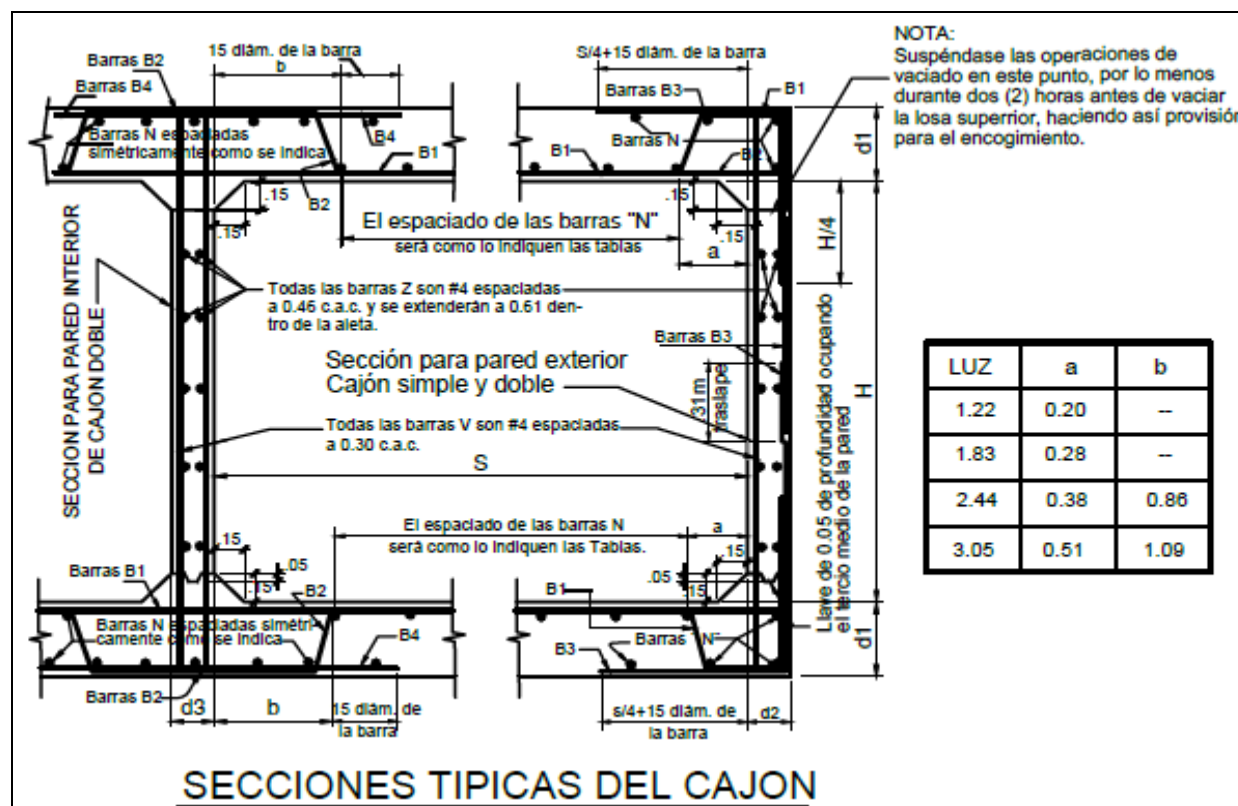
Sección longitudinal de los cajones a utilizar en la Carretera Caimito – Cañazas
